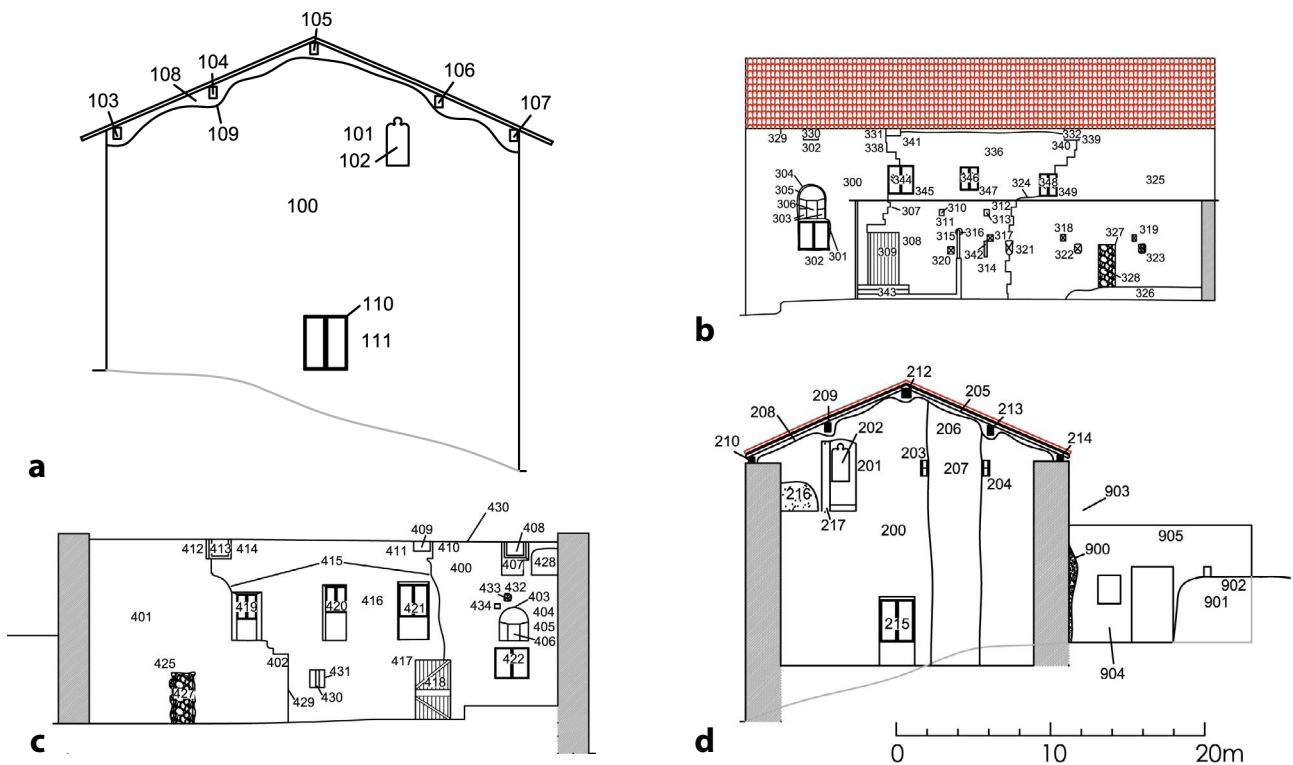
Estudo estratigráfico das fachadas do *caserío* Urdaiaga: a) fachada norte exterior; b) fachada oeste exterior; c) fachada oeste interior; d) fachada norte interior. Autor: Xabier Alberdi Lombide.
